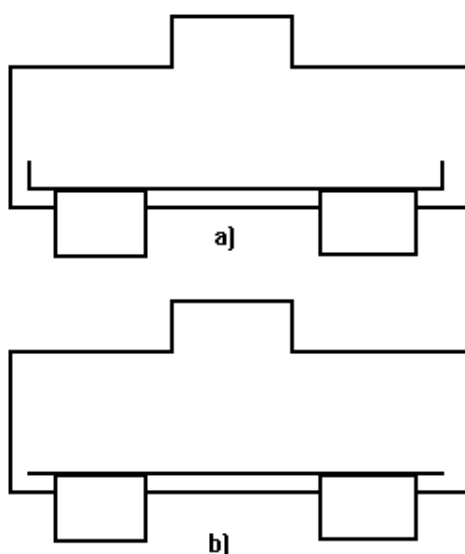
Disposições das armaduras (BLÉVOT, 1967)
